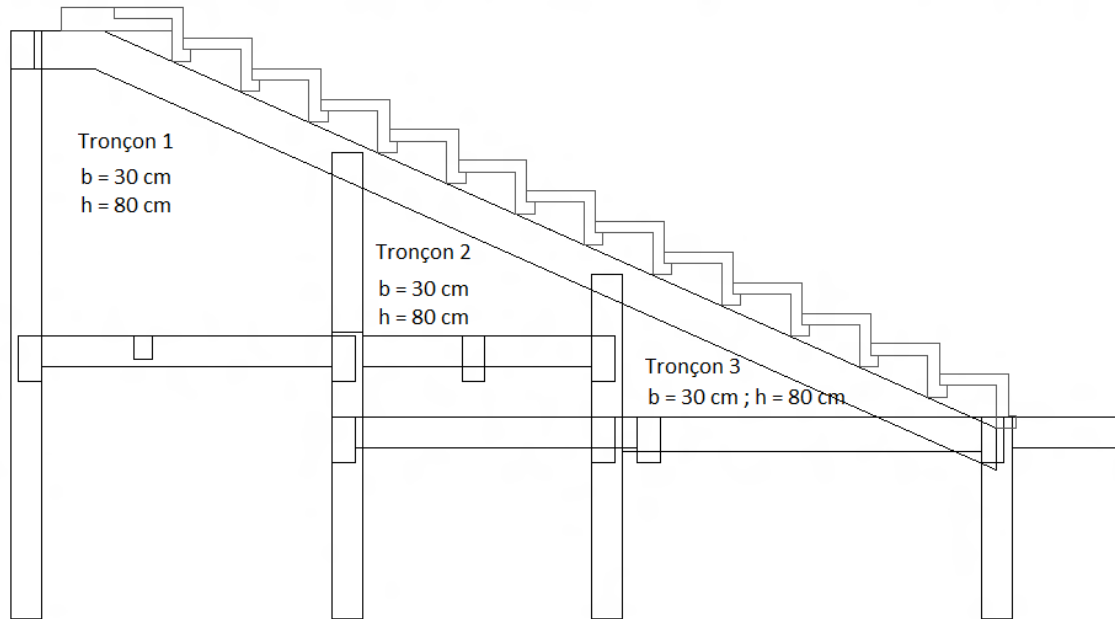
Schéma d'un portique avec la poutre crémaillère en haut
